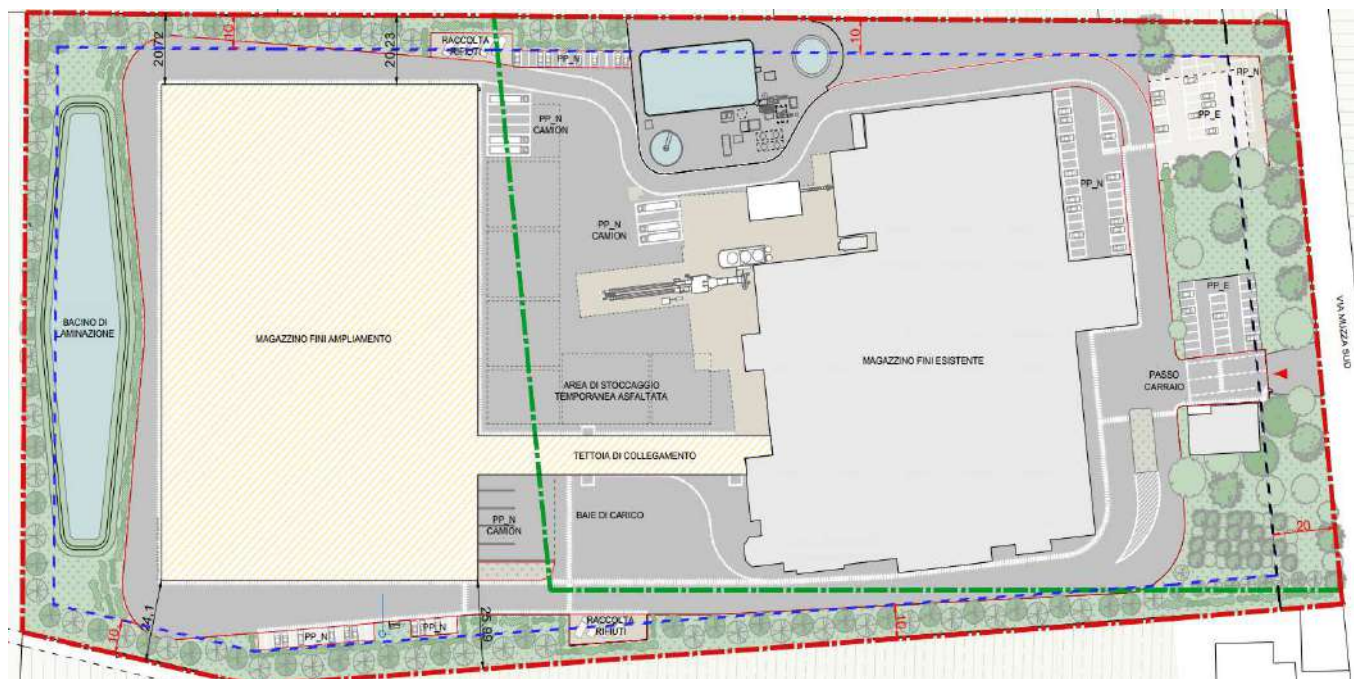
Planimetria generale futuro Stabilimento GRUPPO FINI S.p.A. Via Confine nr. 1583 Ravarino (MO)
